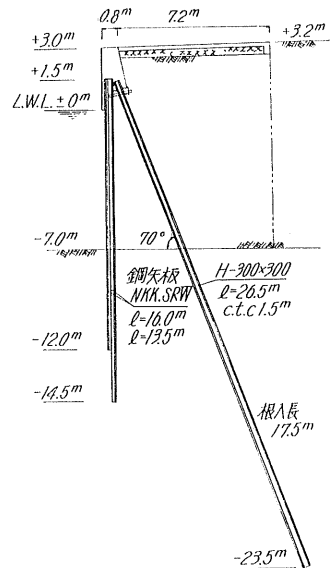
函館北浜埠頭 -5.5 m 岸壁標準断面図
